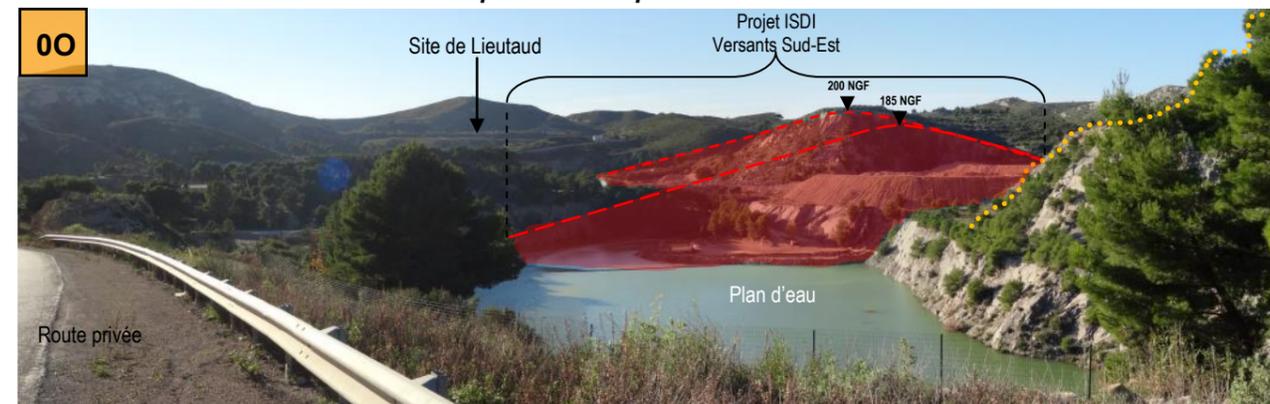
Vue depuis la route privée LAFARGE - Sud Est de la carrière
